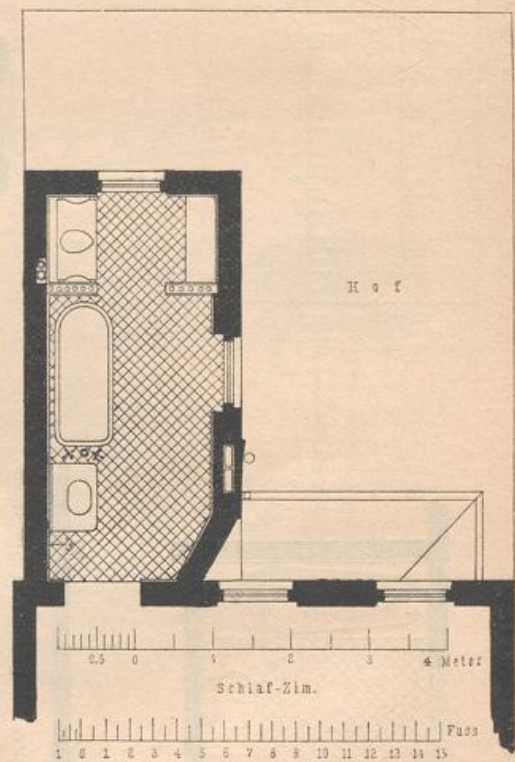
stellt im Grundriss die getrennte Anordnung eines Badezimmers und
